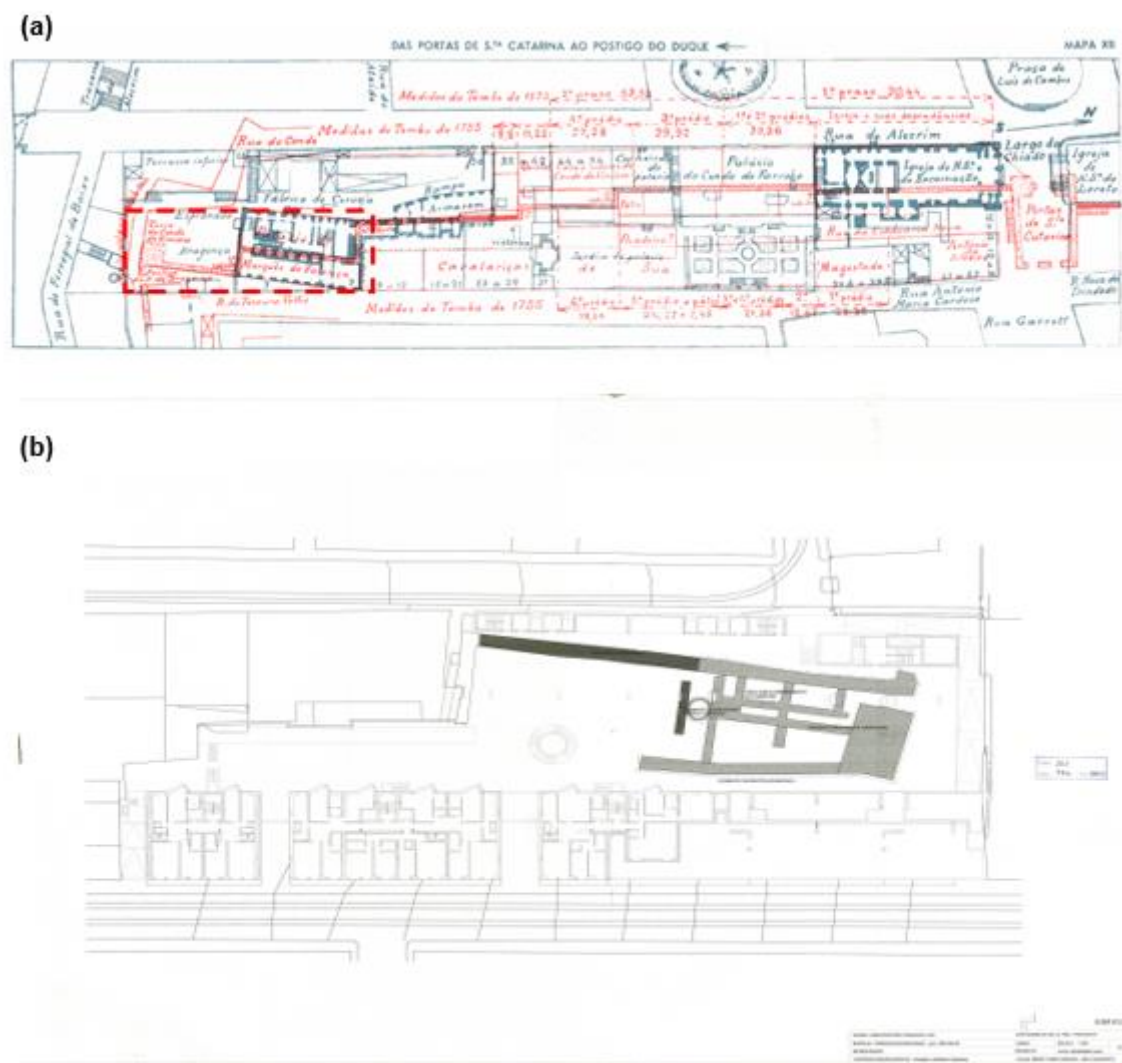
Localização a tracejado do complexo em planta (adaptado de Vieira da Silva, 1987b) (a); Planta do projeto inicial com evidência a negro dos vestígios arqueológicos a restaurar (b)
